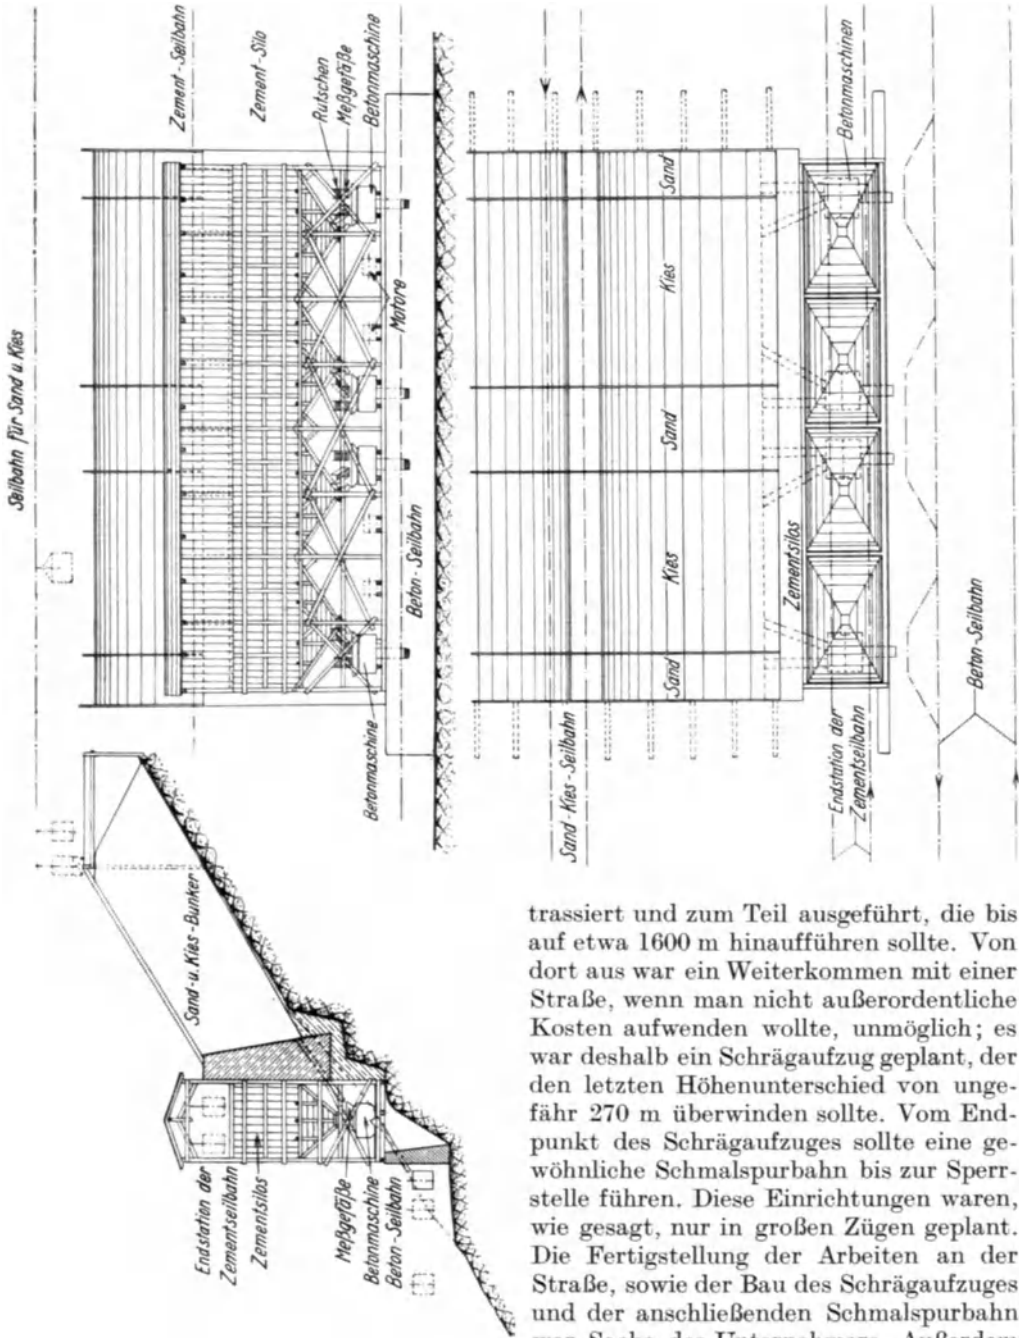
Aufbereitungs- und Betonierungsanlage.
